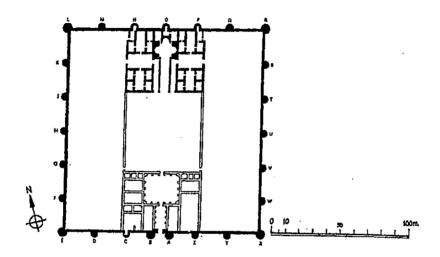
مسقط أفقي لقصر الأخيضر عن: الحداد، المجمل، شكل (٥١).
